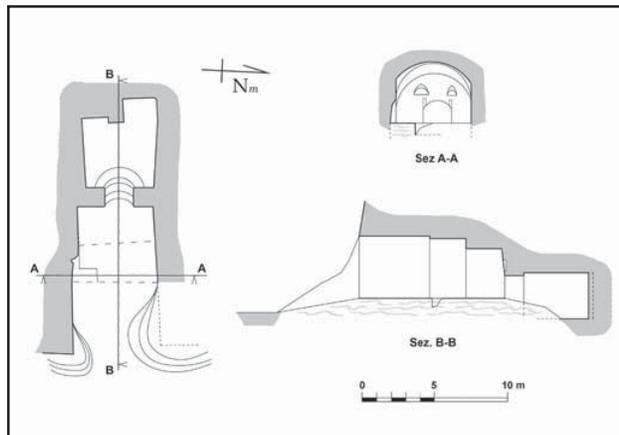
Planimetria e sezione dell'ipogeo n. 69 (Copyright CRSE).
